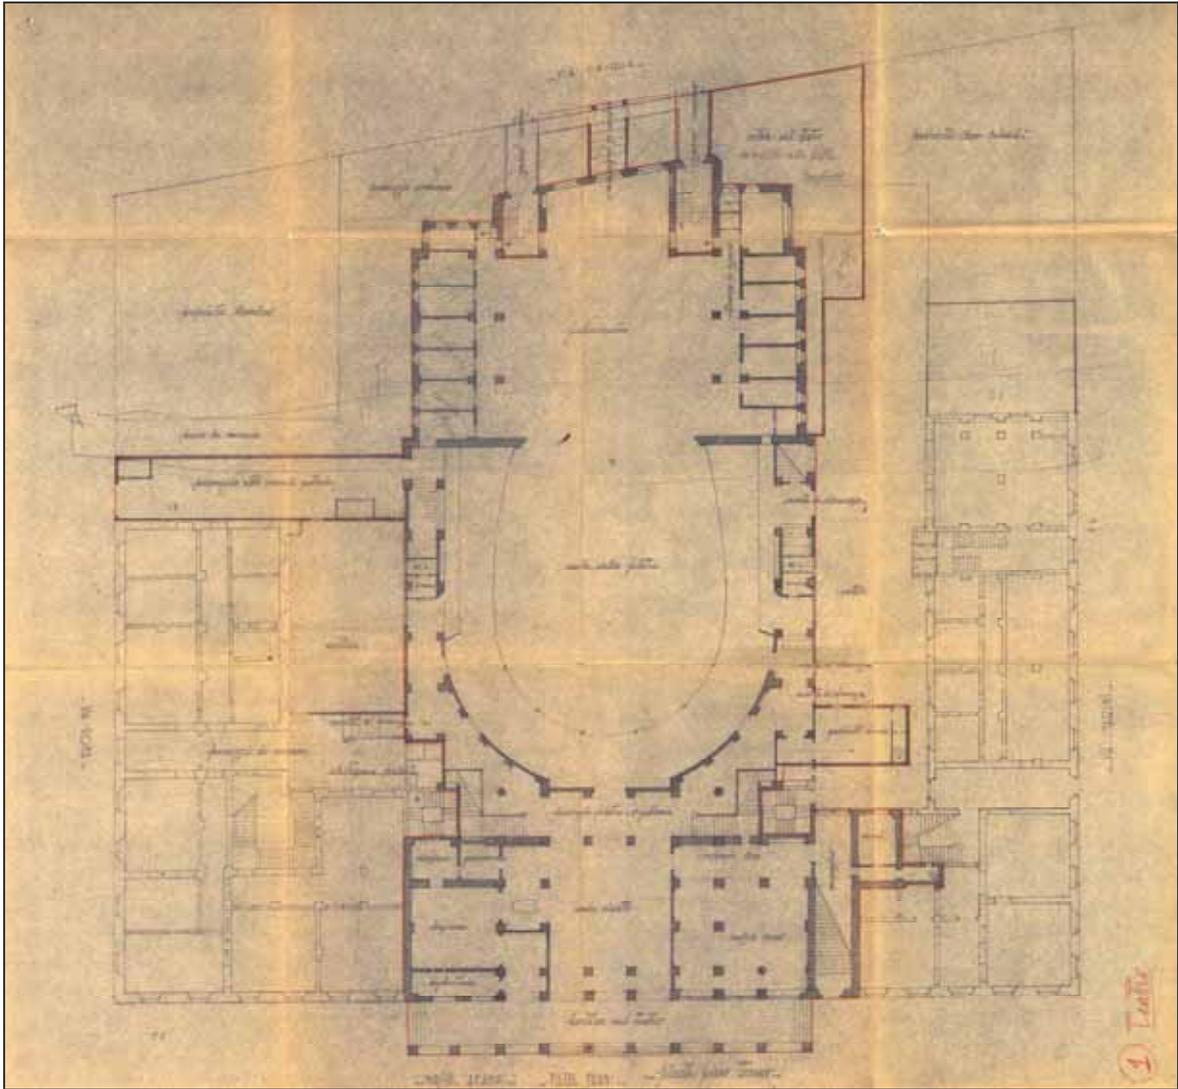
Piantina del Teatro a piano terra, Archivio privato Scarzella, Milano.
